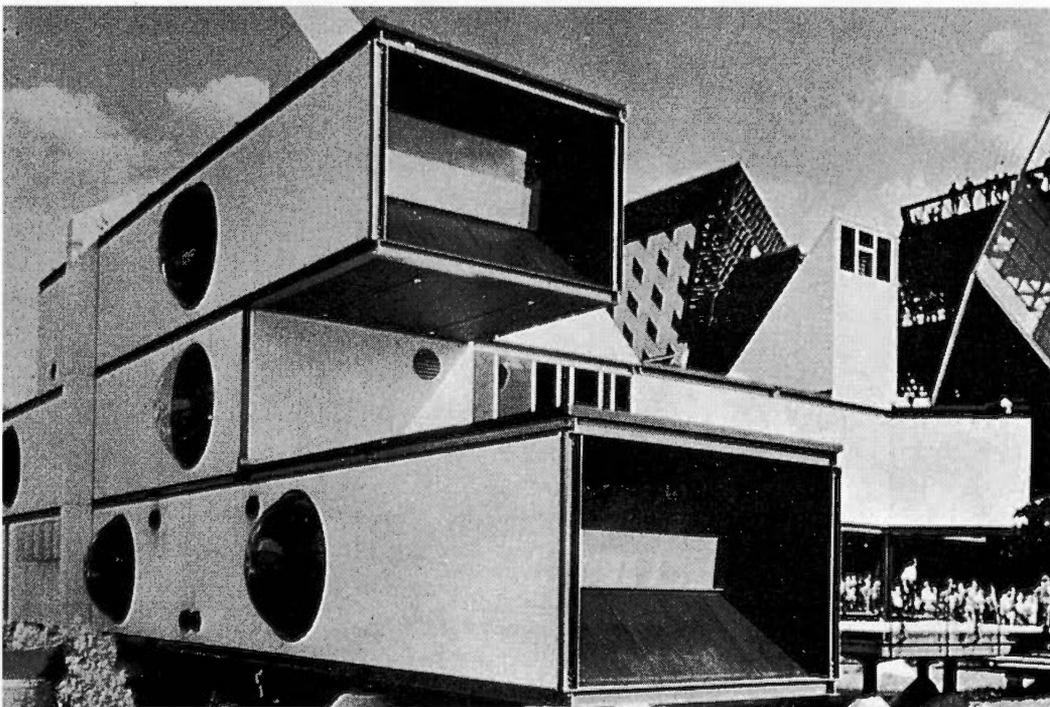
Boîtes superposées avec poutres de rive apparentes
